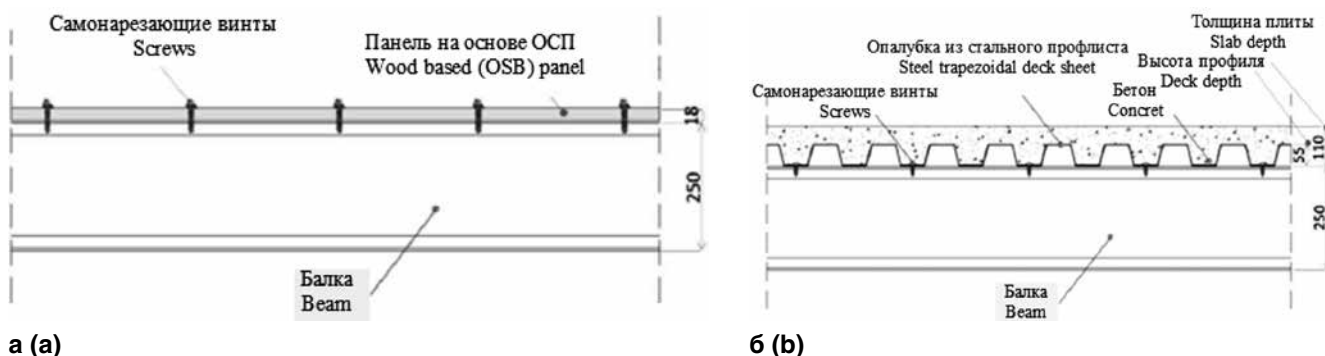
Конструкция плит перекрытий экспериментального образца LAMIEREDIL (размеры в мм) [33]:
